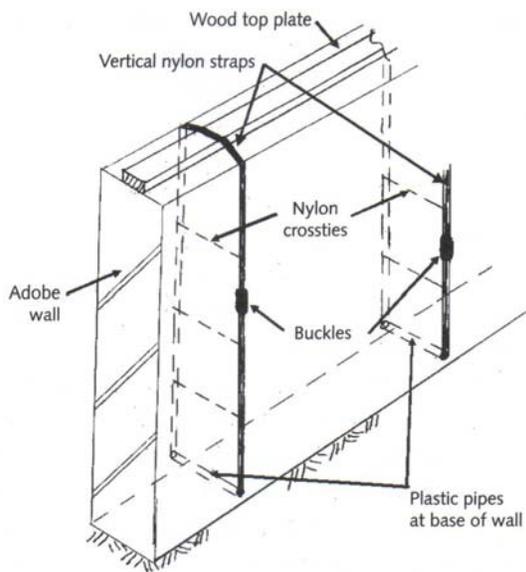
Detalle de la unión de los tirantes verticales con sogas de nylon.
